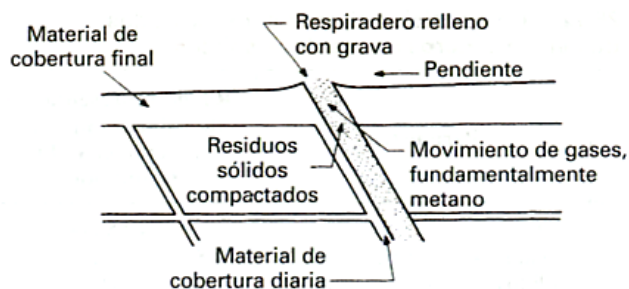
Vista transversal de un sistema de drenaje interno
